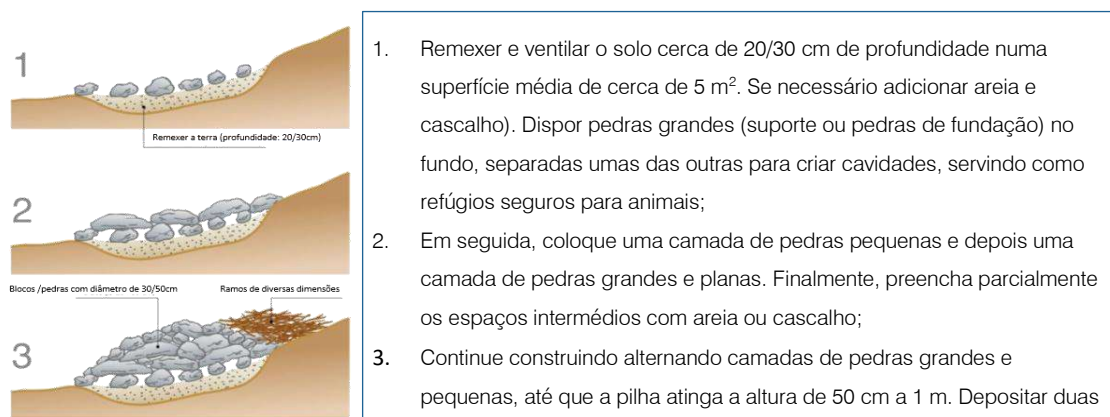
Fases de construção das estruturas de abrigo combinadas
